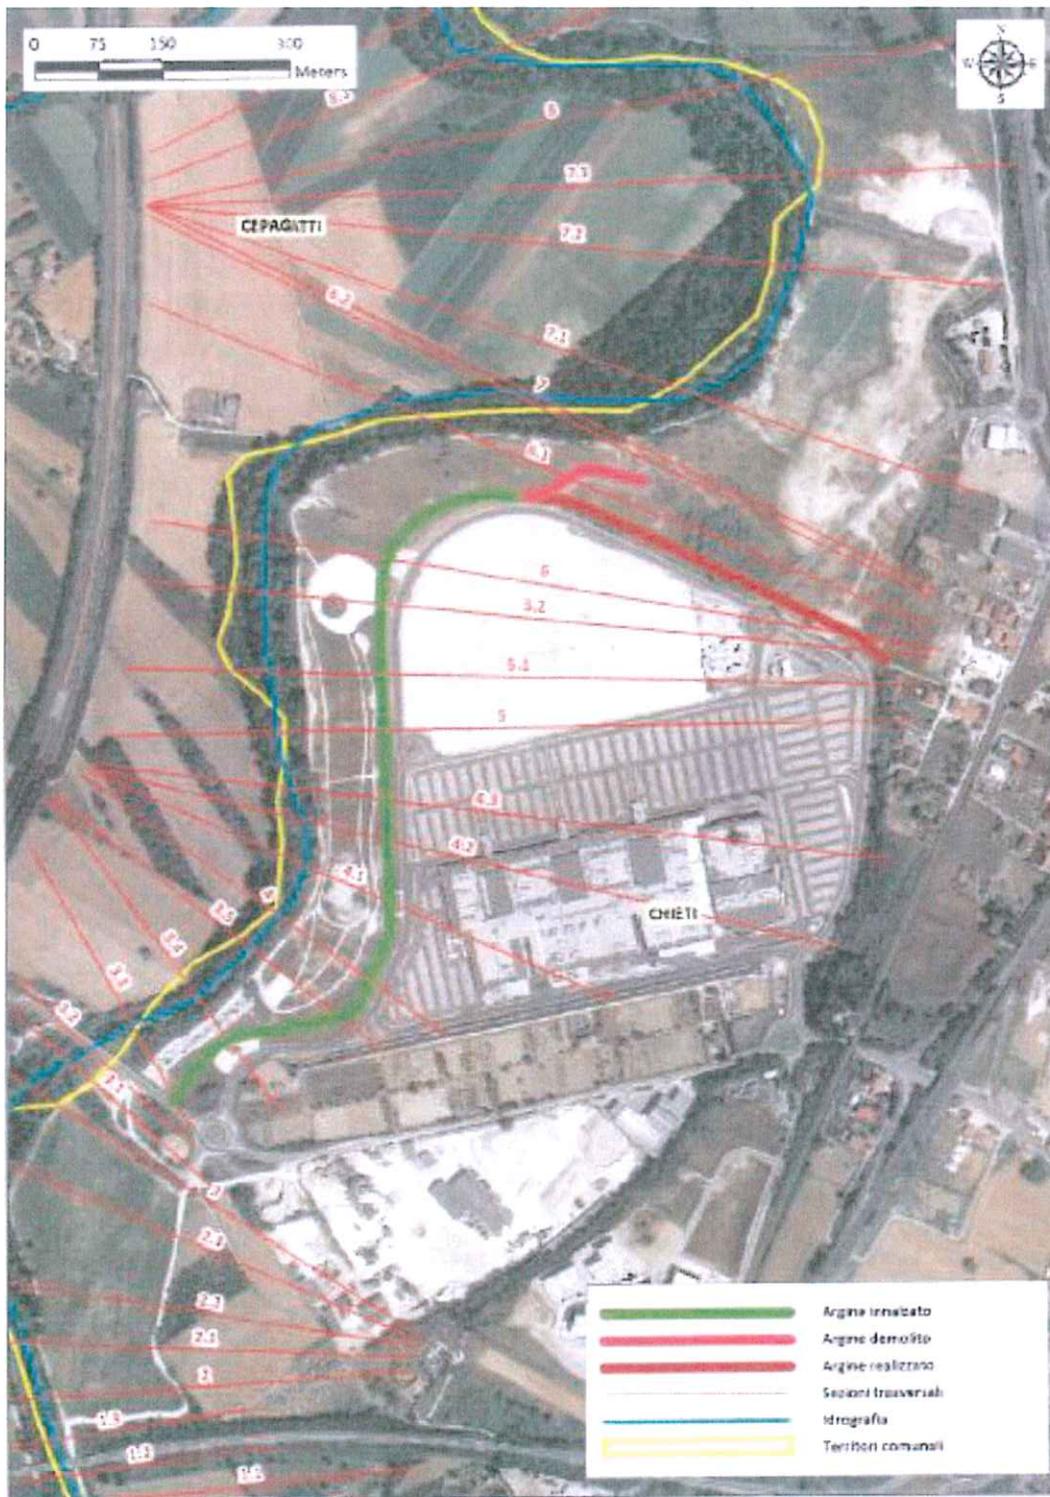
Planimetria dell'area di interesse con l'indicazione degli interventi realizzati su base ortofoto
